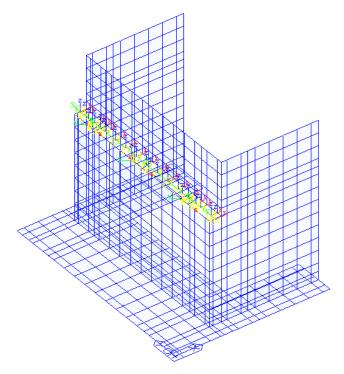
Vista 3D del modello di calcolo Spalle
